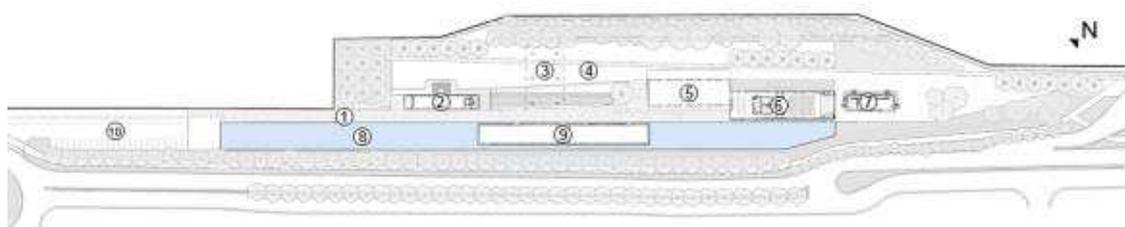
Planta baixa do Projeto de reabilitação do Centro Cultural de Araras.
